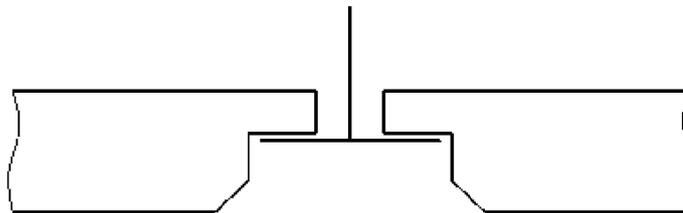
Gips-Deckenplatten mit gefalzter, abgeschrägter Kante
